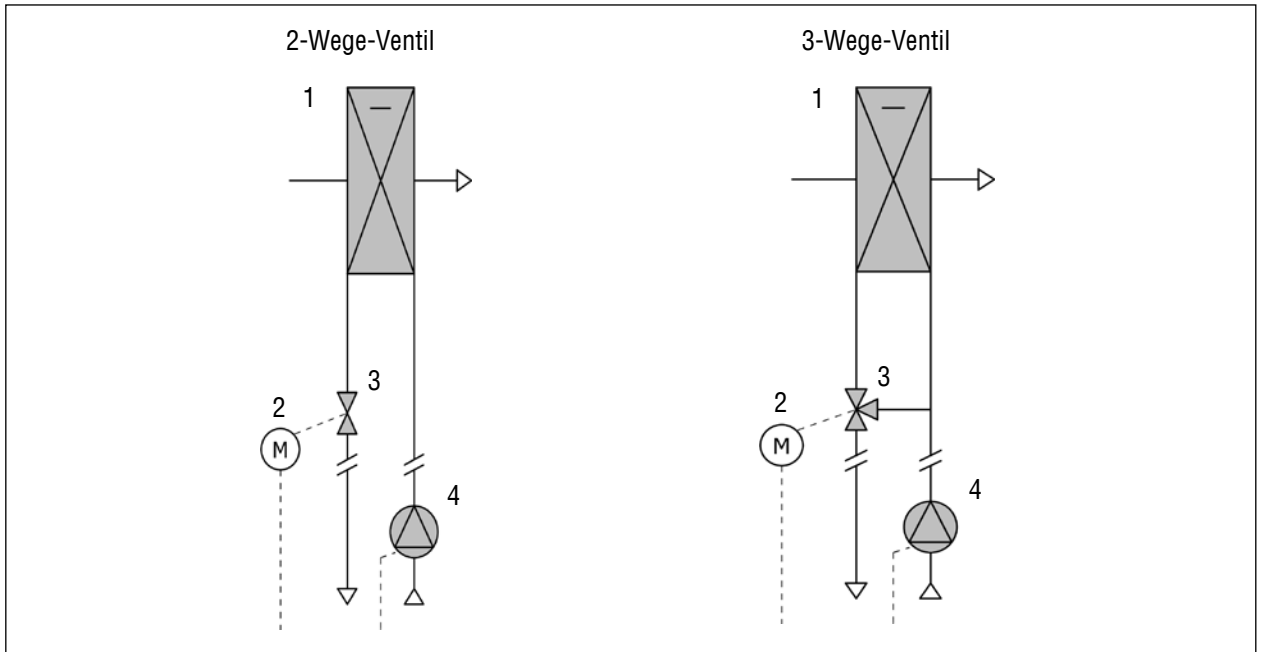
Anschlussausführungen mit 2-Wege-Ventil und 3-Wege-Ventil
